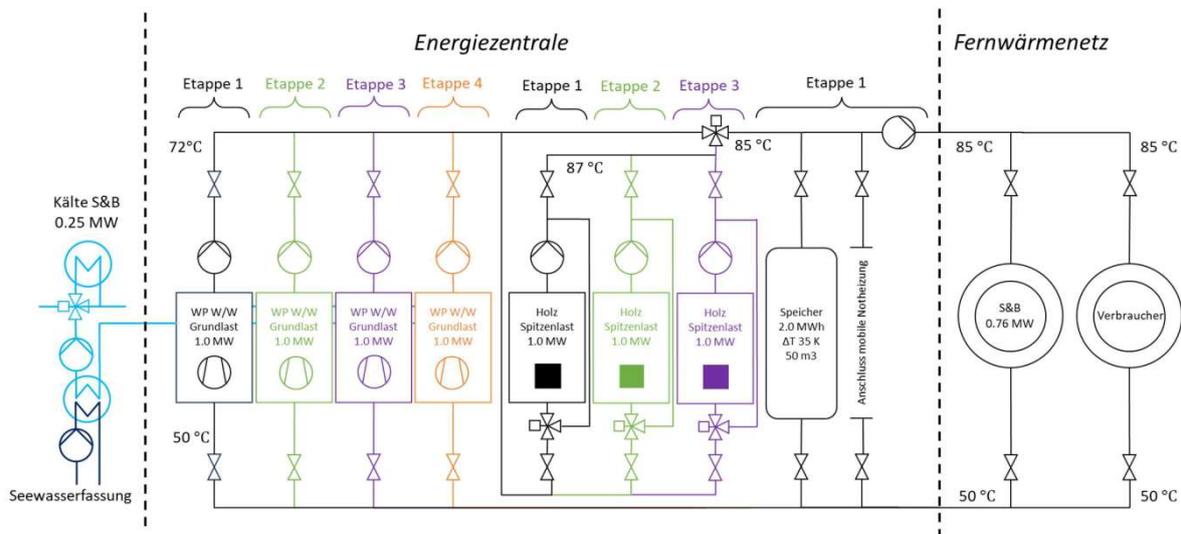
Prinzipschema - Heizzentrale mit Etappierung
